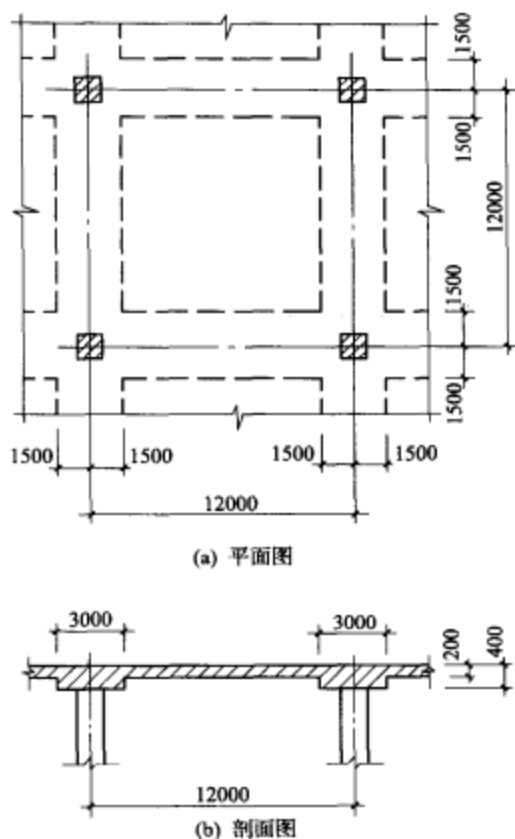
例 4-10 的双向板-梁楼盖平面与剖面图
